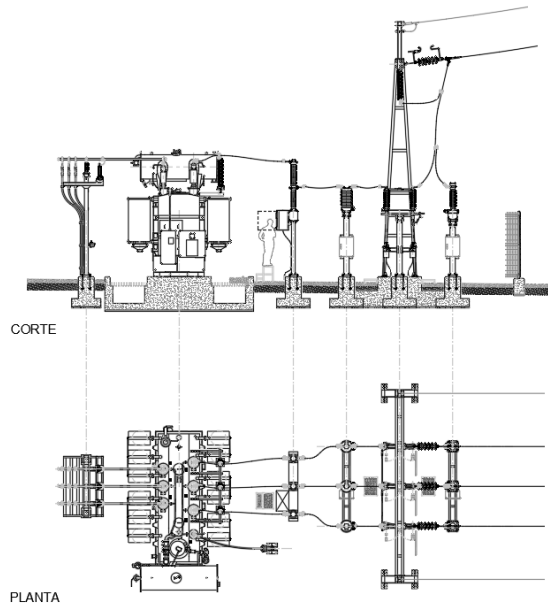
Planta e Corte da Subestação 60/30kV da Central Solar Fotovoltaica de Mogadouro
